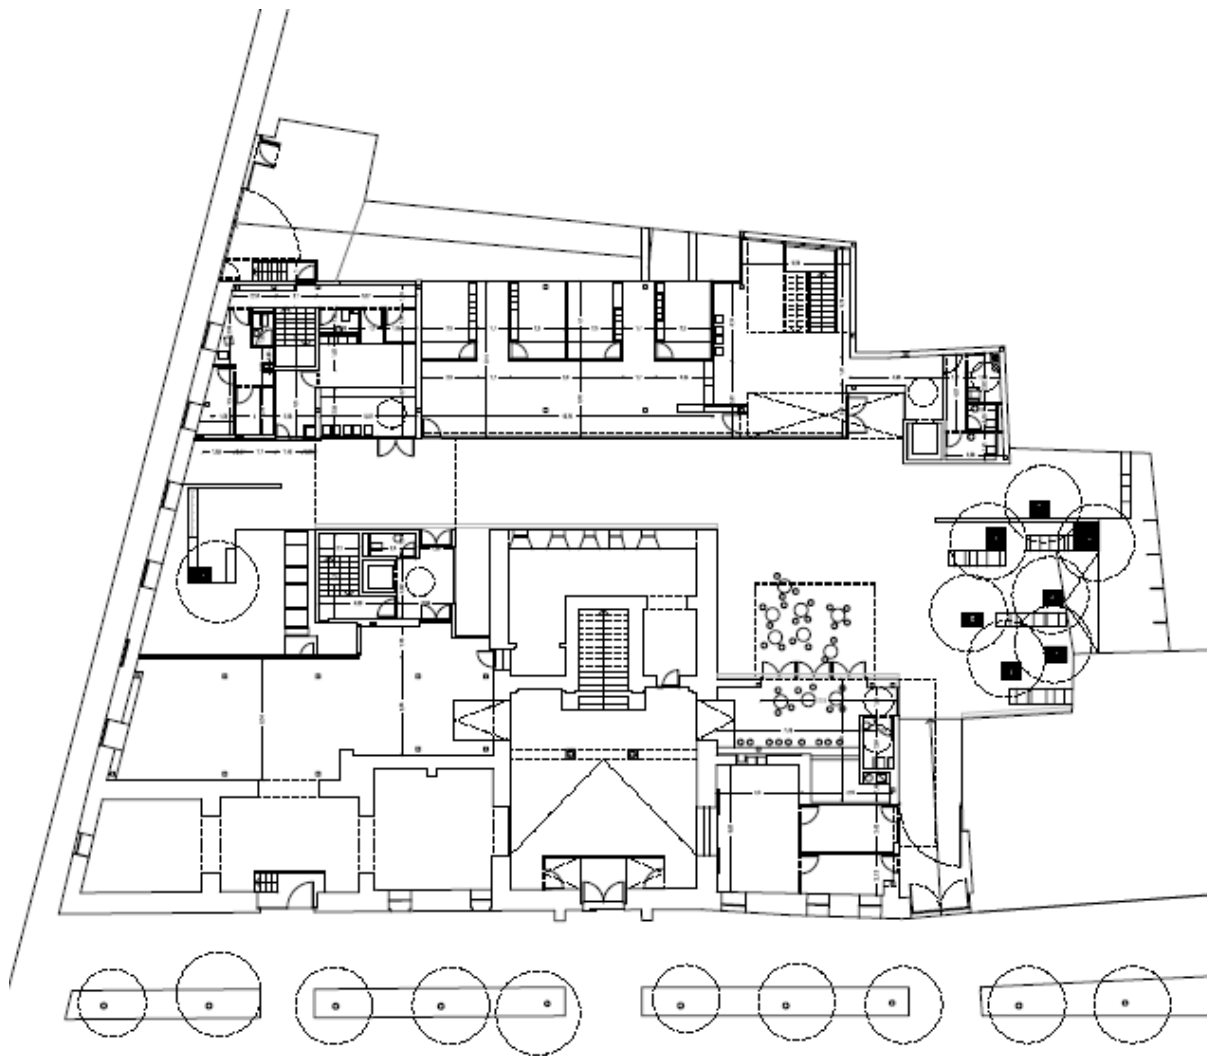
Planta baja. Estado reformado. *Rehabilitación de las Casas Consistoriales*. ADOUAB, sección proyectos.
